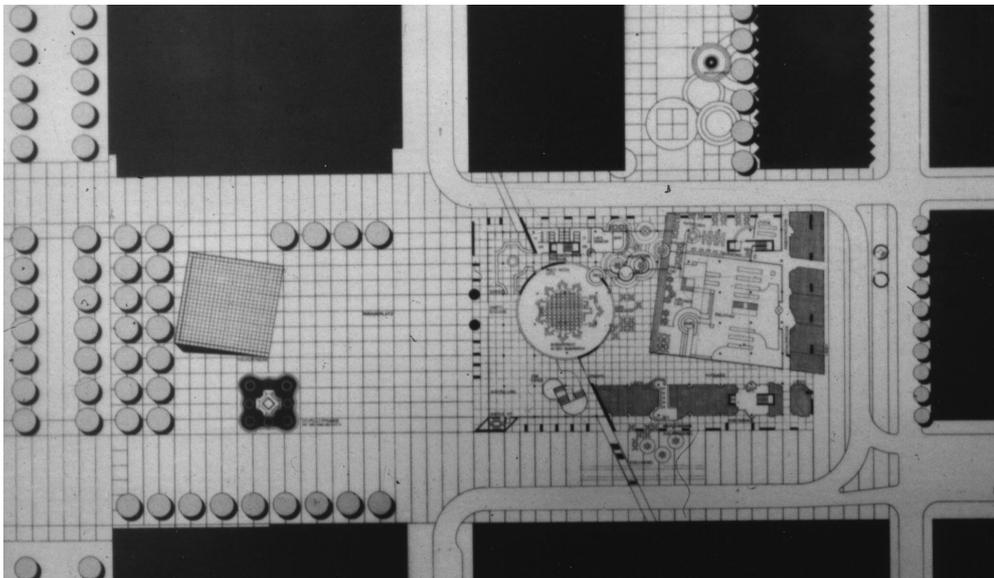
Lando Reichel, Erdgeschoßgrundriß mit Freiflächengestaltung
